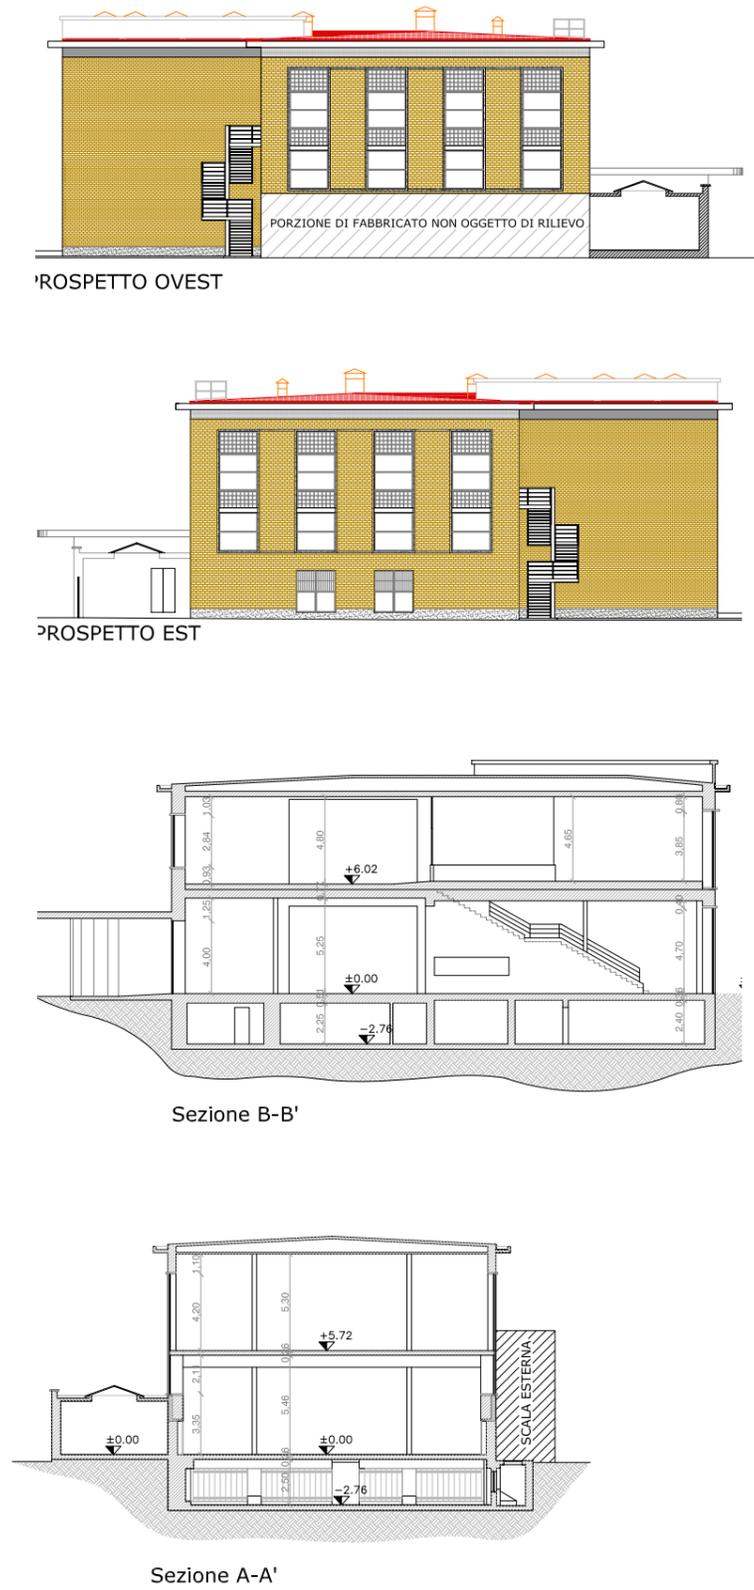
| “Stato di fatto - Sezioni AA e BB, Prospetti Est e Ovest“, 2011 | fonte: Arch. Marina Basso
